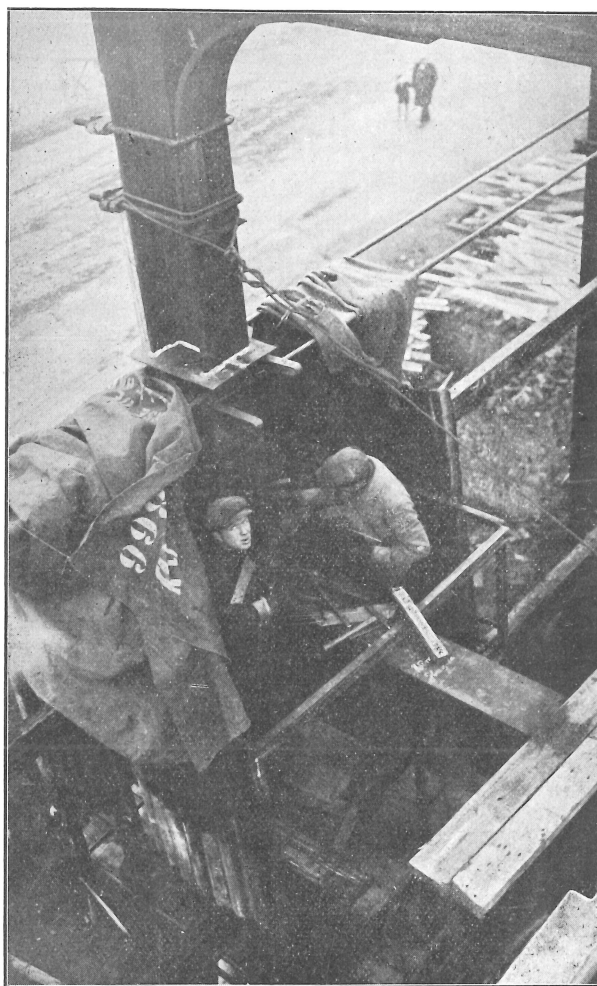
Soudure au chantier d'un assemblage de poutre du laboratoire d'hydraulique (1932).
